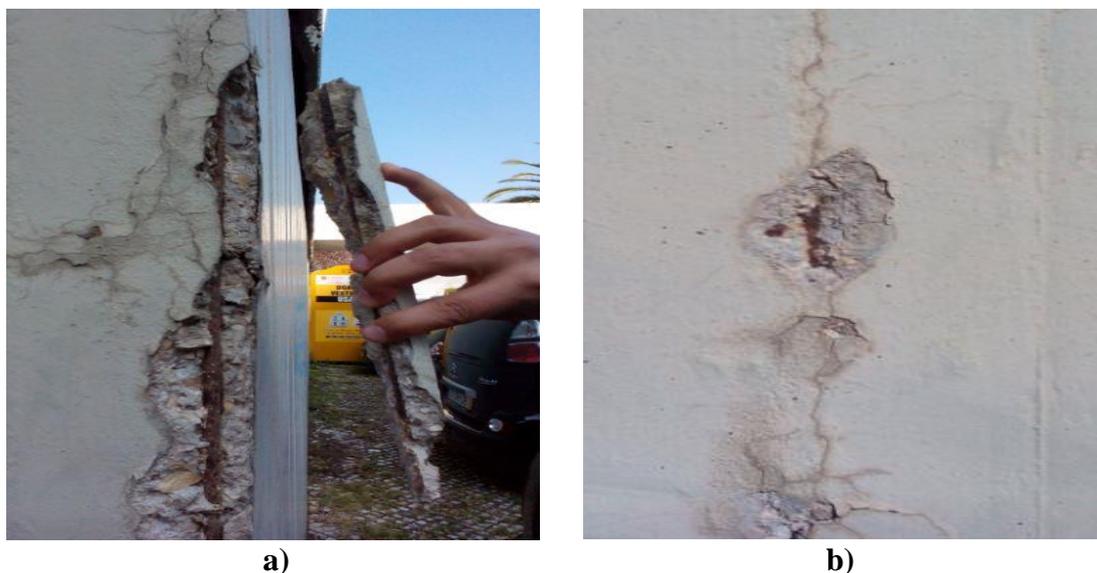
a) Destacamento de betão na parede da cave (Autor: H M); b) Armadura exposta na parede da cave (Autor: H M)
